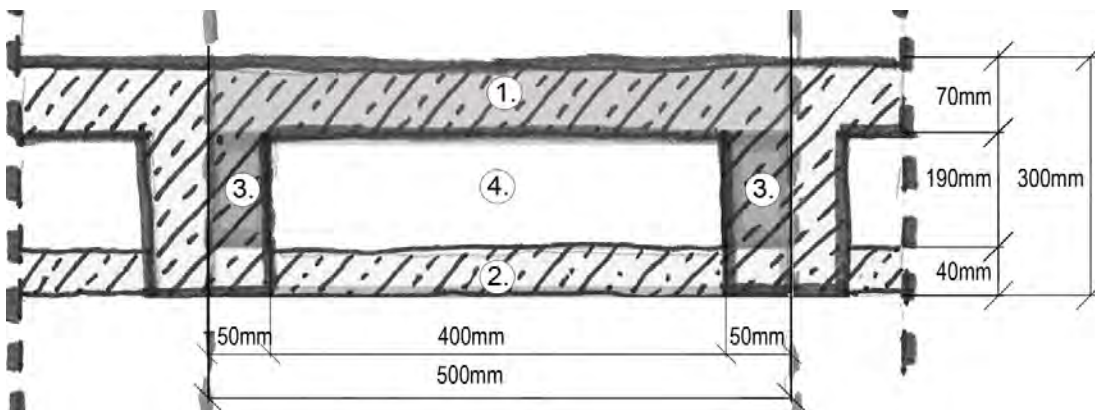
Probenabschnitt Hohlraumdecke Bestand_30cm_7cm
